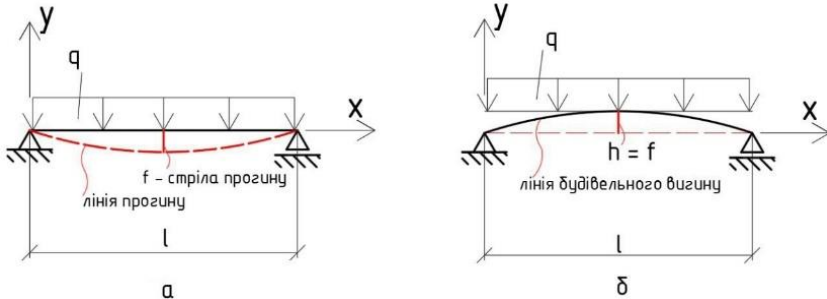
Схема шарнірно опертій двохопорної балки:
